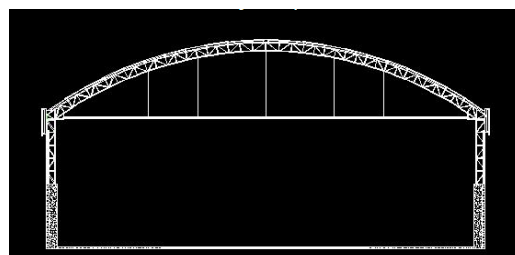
Pórtico em viga celular. Fonte: Best Practice in Steel Construction
